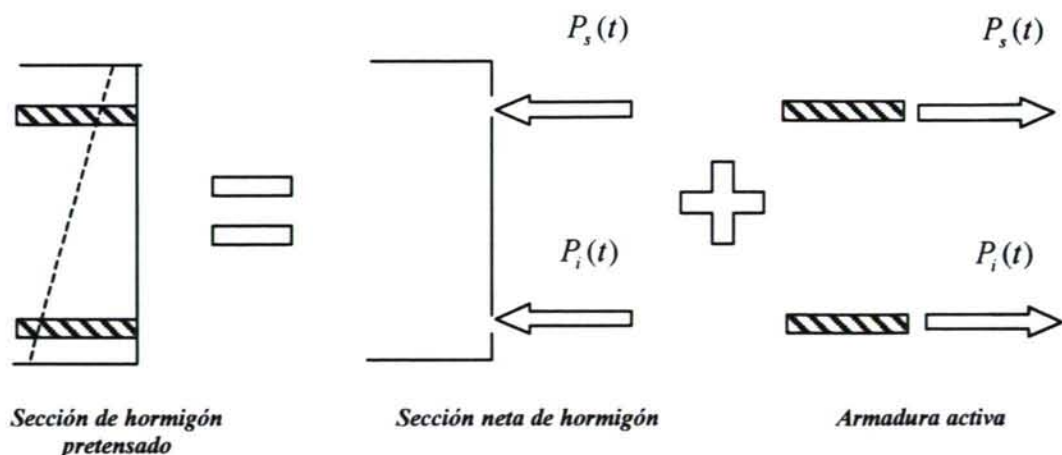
Equilibrio dentro de la sección de hormigón pretensado
